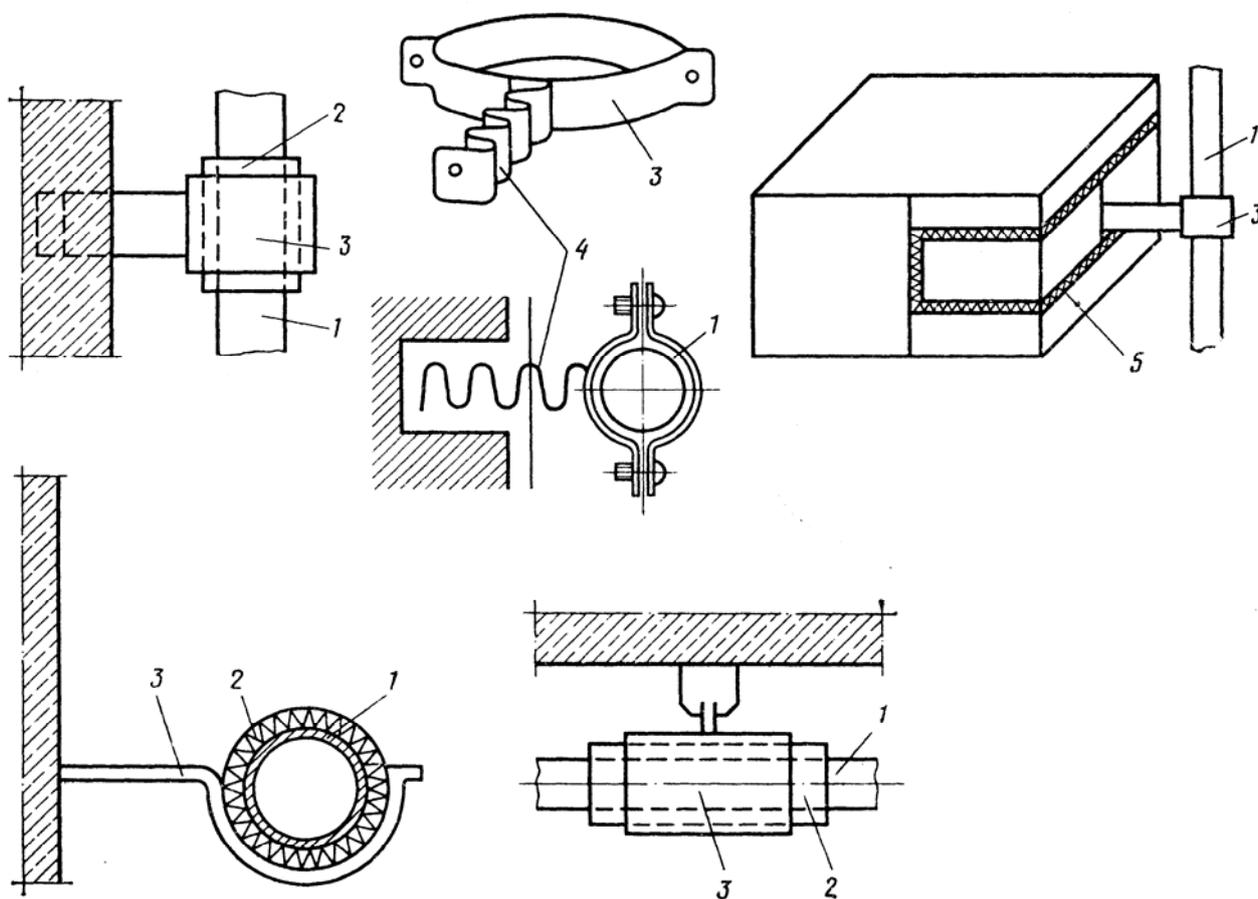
Схемы крепления труб центрального отопления к стенам и перекрытиям отопительного узла:
